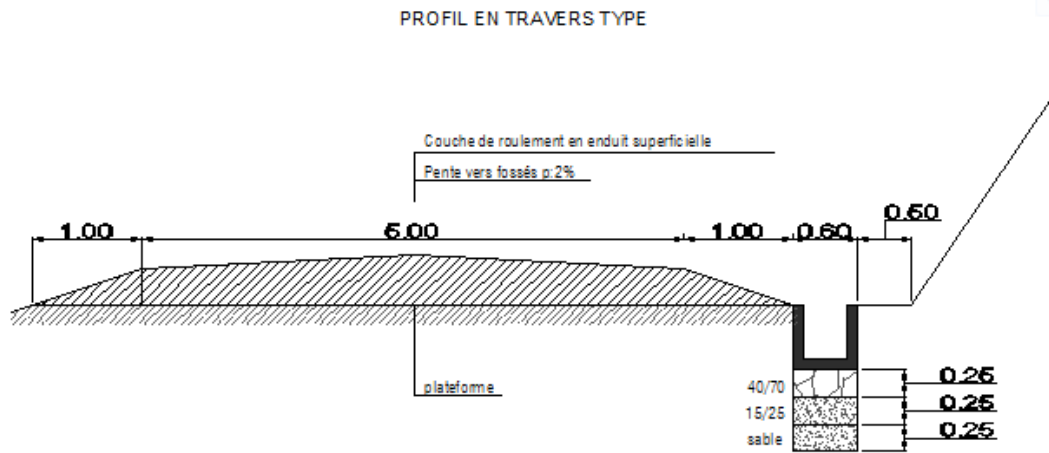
PROFIL EN TRAVERS TYPE PROPOSÉ POUR LA ROUTE DE RAMENA, AVEC EXÉCUTION DRAIN
